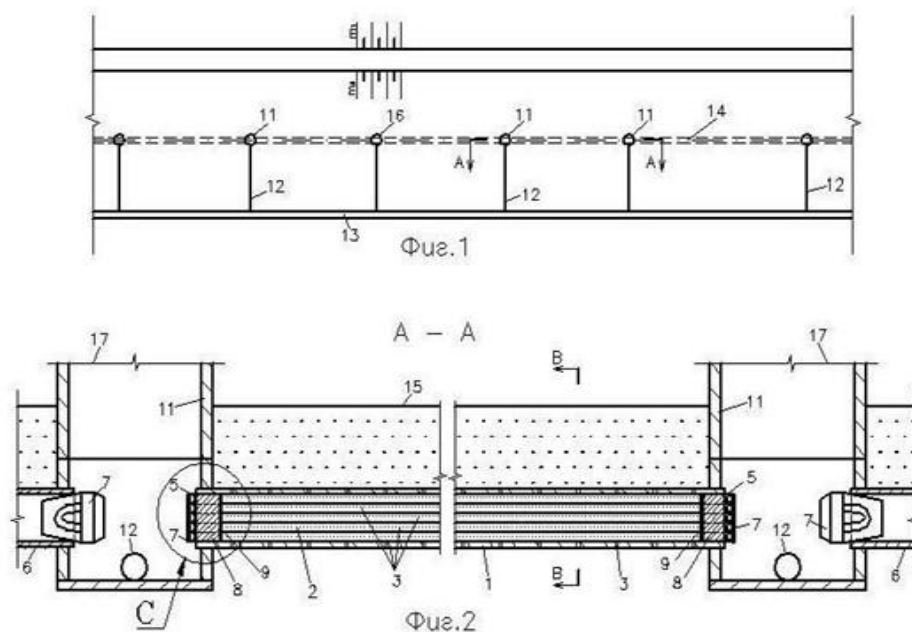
Горизонтальный трубчатый дренаж грунтовых плотин (Фиг.1. План низового откоса; Фиг.2. Продольный разрез по оси дренажа).
